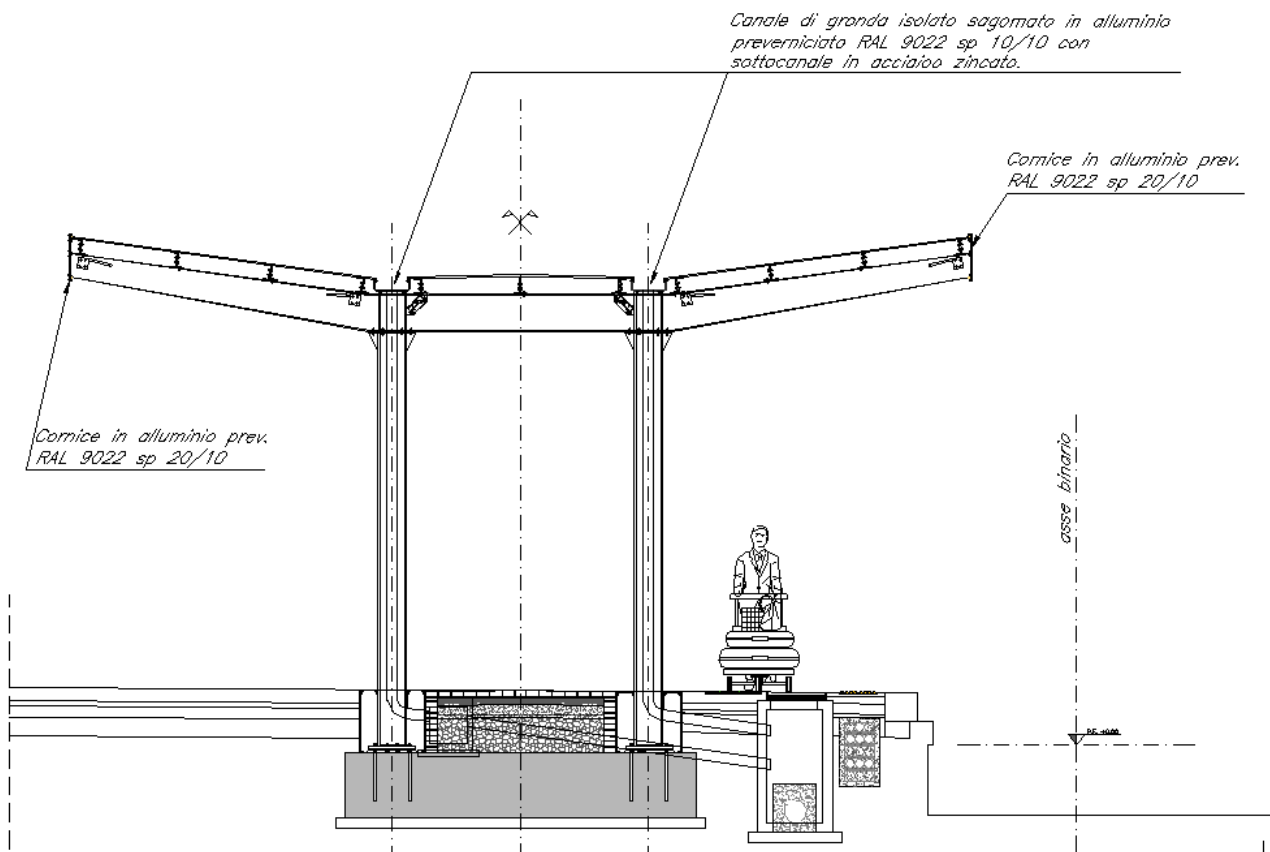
Sezione pensilina ferroviaria 3° marciapiede
